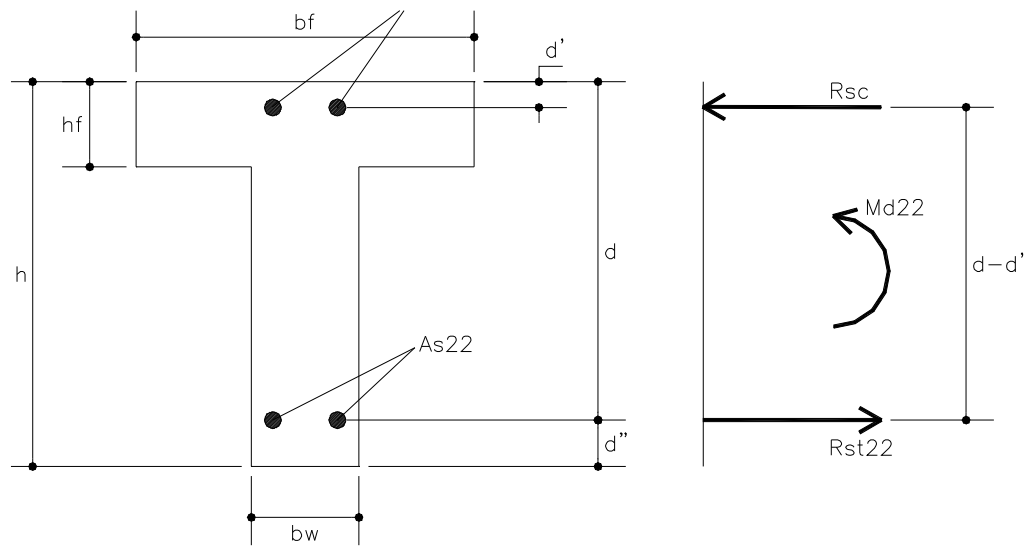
Viga de seção T super-armada com parcela comprimida da armadura
